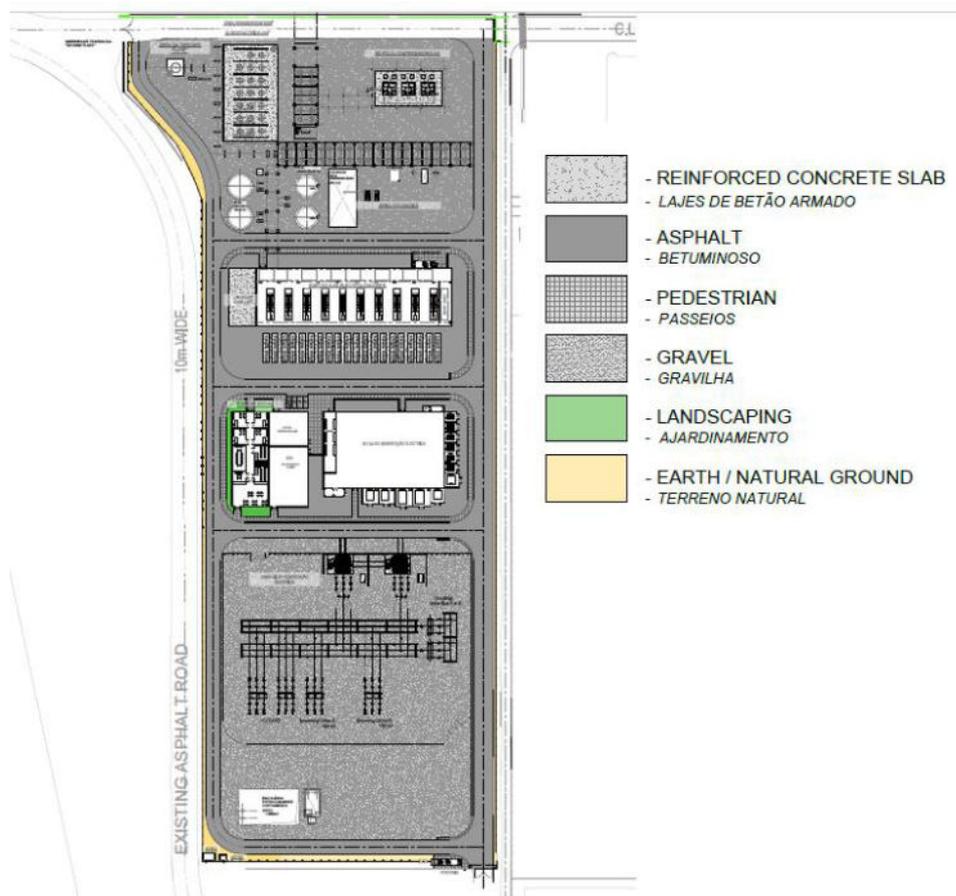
Planta de Pavimentos e Arranjos Exteriores
